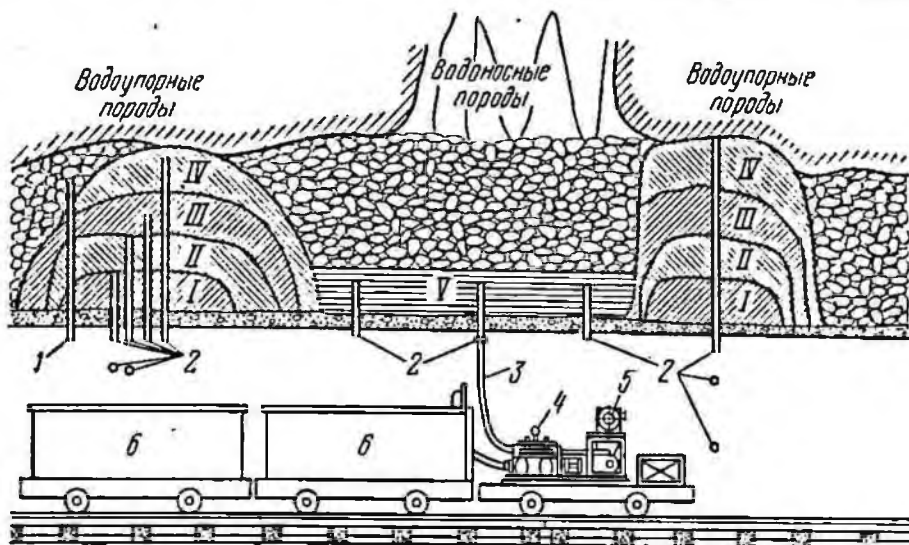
Схема создания водоизоляционной завесы в горизонтальной выработке: I, II, III и IV — этапы устройства водоизоляционной завесы; V — водонепроницаемый экран вокруг постоянной крепи выработки; 1 — контрольная скважина; 2 — тампонажные скважины; 3 — нагнетательный растворопровод; 4 — растворонасос; 5 — растворомешалка; 6 — вагон с цементом
